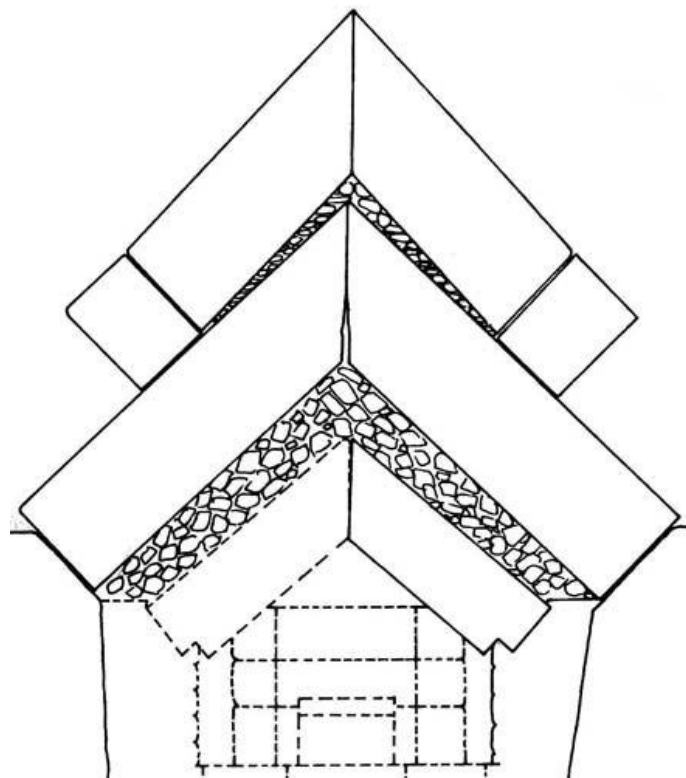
Схема перекрытия камеры пирамиды Ниусера
